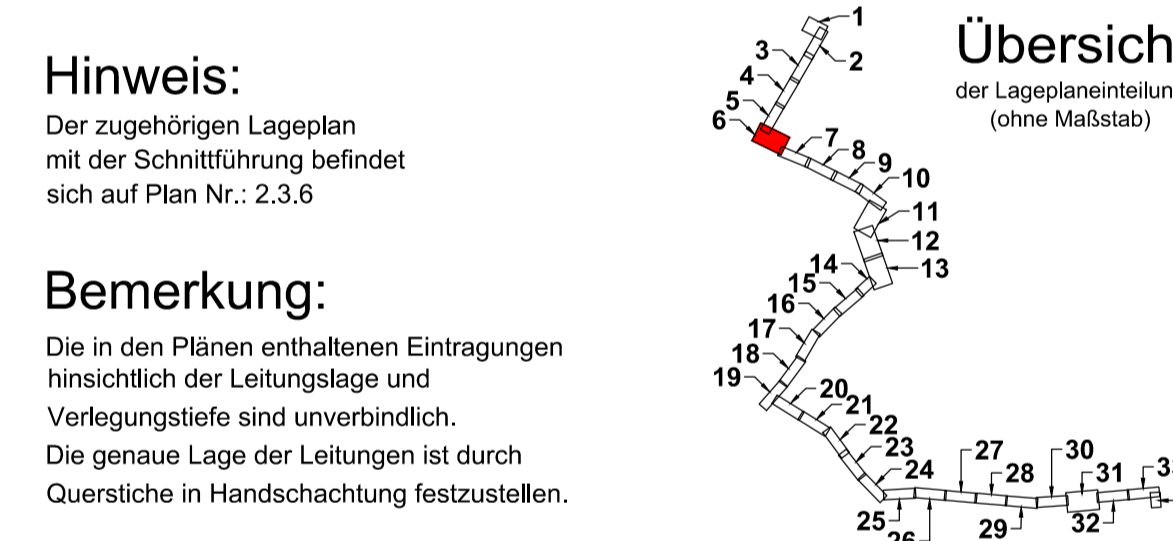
Rohrbrücke B1 "Kuhgraben"
